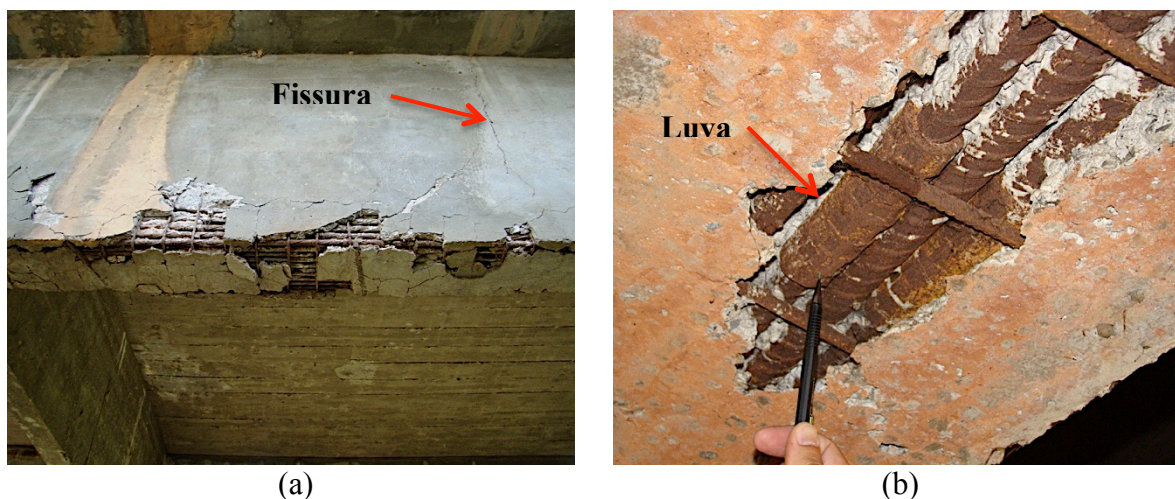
Falhas de concretagem: (a) falha de concretagem e fissura transversal ao longo de toda a altura da viga; (b) luva obstruindo a passagem do concreto.
